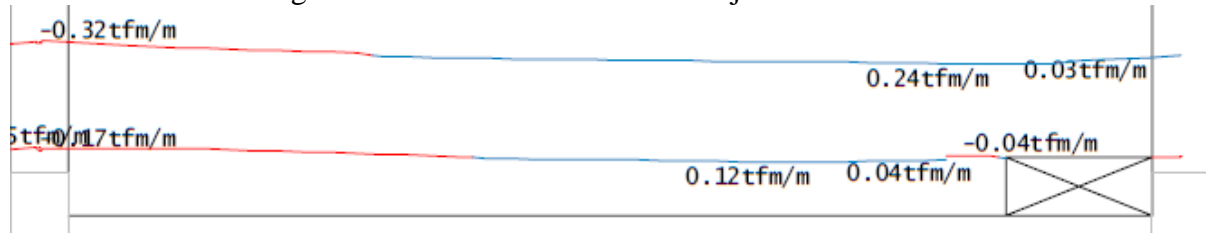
Armaduras negativas horizontais e verticais para a laje LA 50/20-01.
